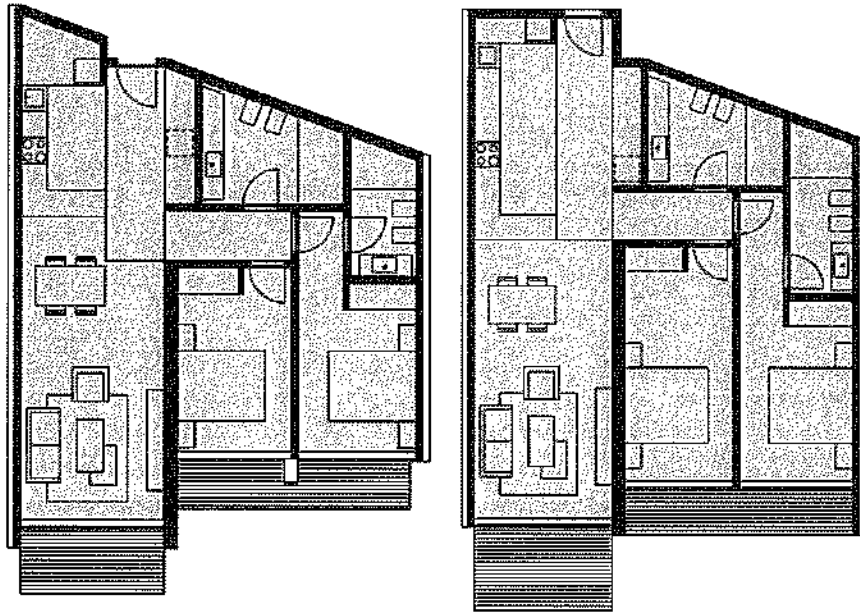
Planimetri e Apartamentit Tip 2+1 – Nënvariate
